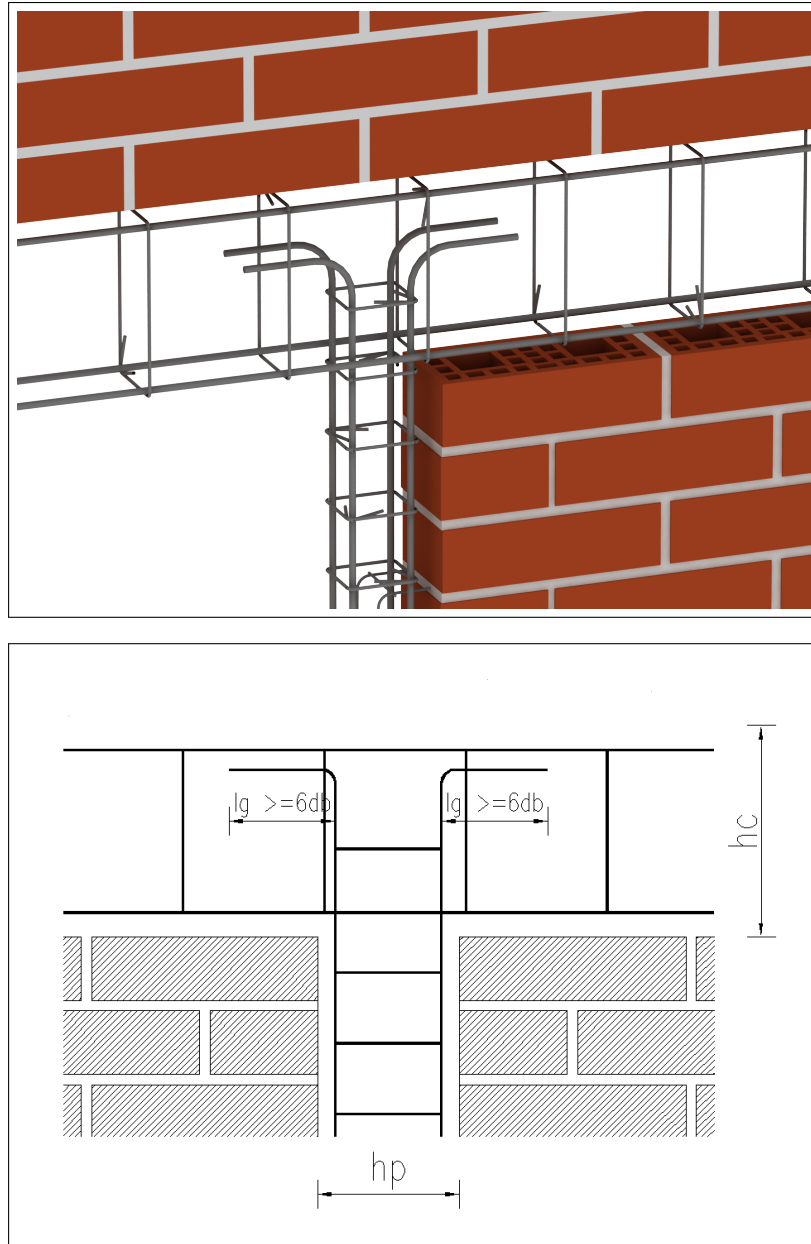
Detalle del anclaje de las barras longitudinales del pilar de confinamiento. Caso B
